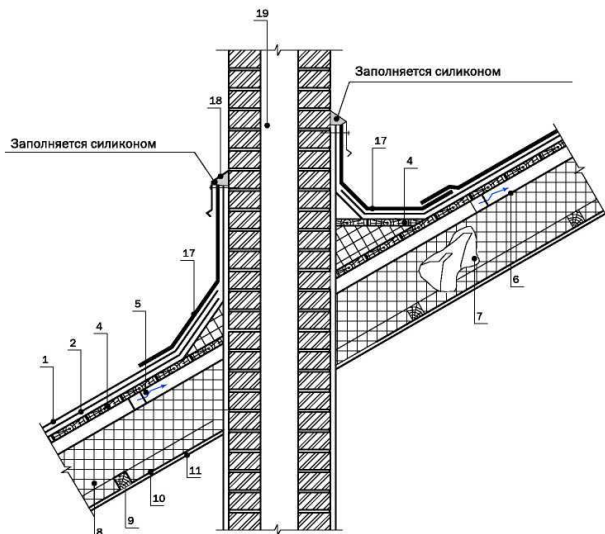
Примыкание кровли к дымовой кирпичной трубе
